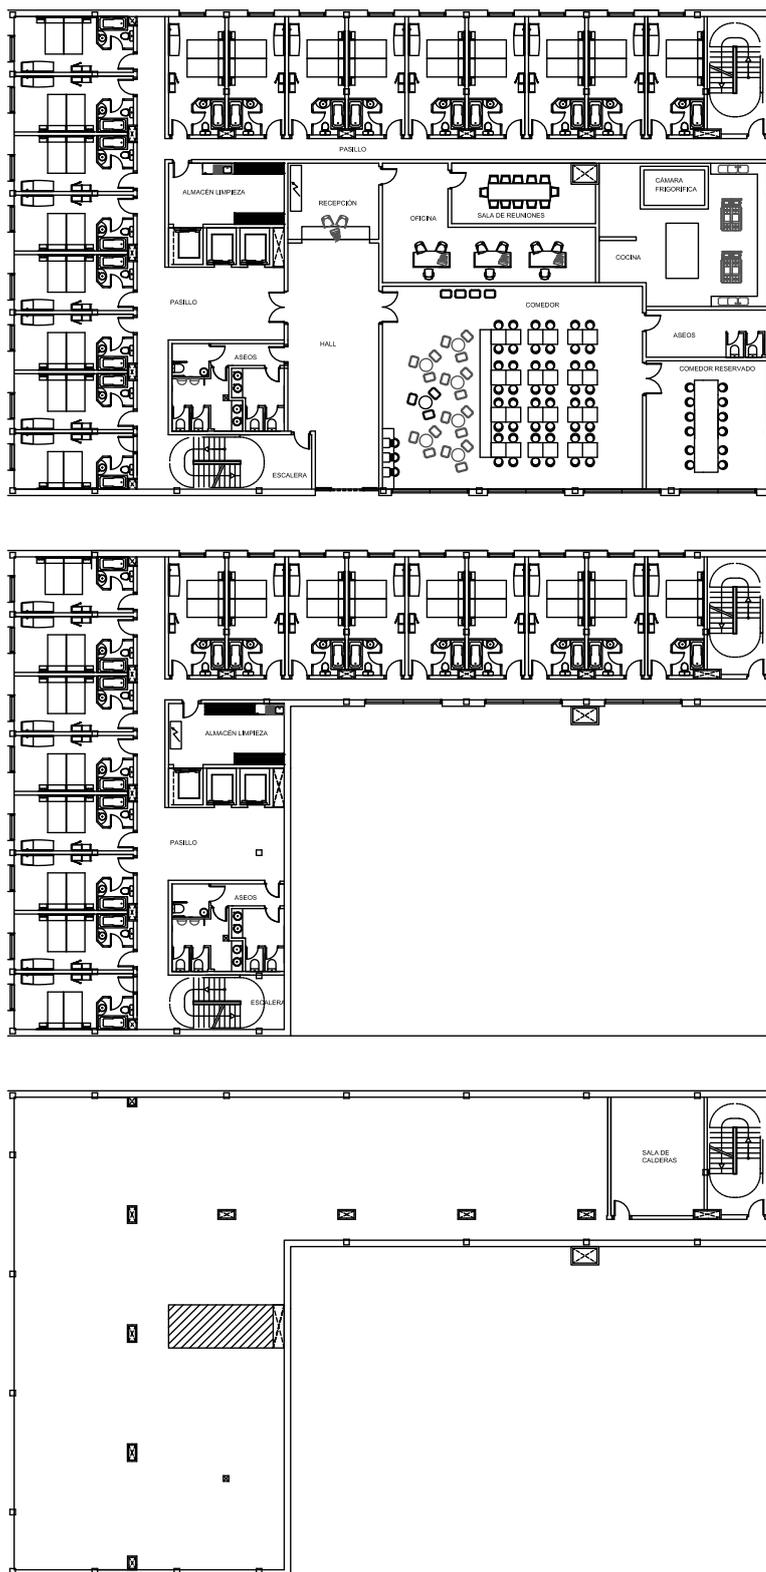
Representación esquemática de la edificación objeto de estudio. De arriba a abajo, planta baja, planta primera y cubierta.
